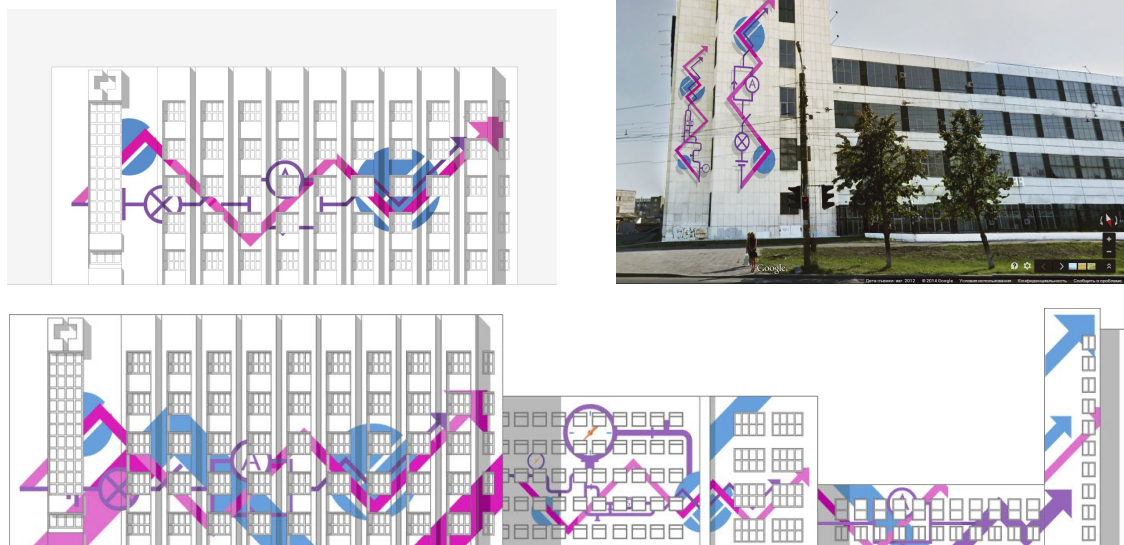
Реконструкция фасада здания ЗАО «ПГ «Метран»». Вариант 1. Использование стилеобразующих элементов на фасадах здания
